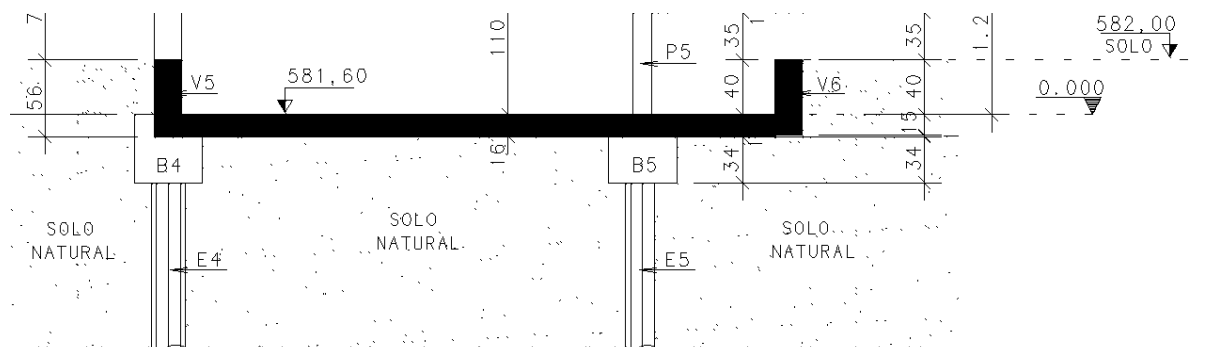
Detalhe em Corte da Fundação (blocos, estacas e vigas).
